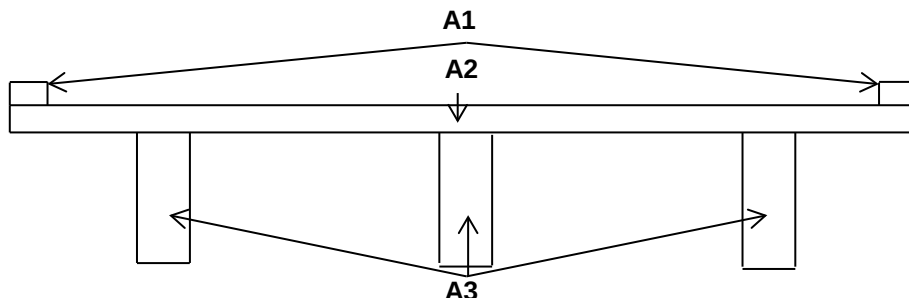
Sección Transversal de la superestructura dividida en áreas.
